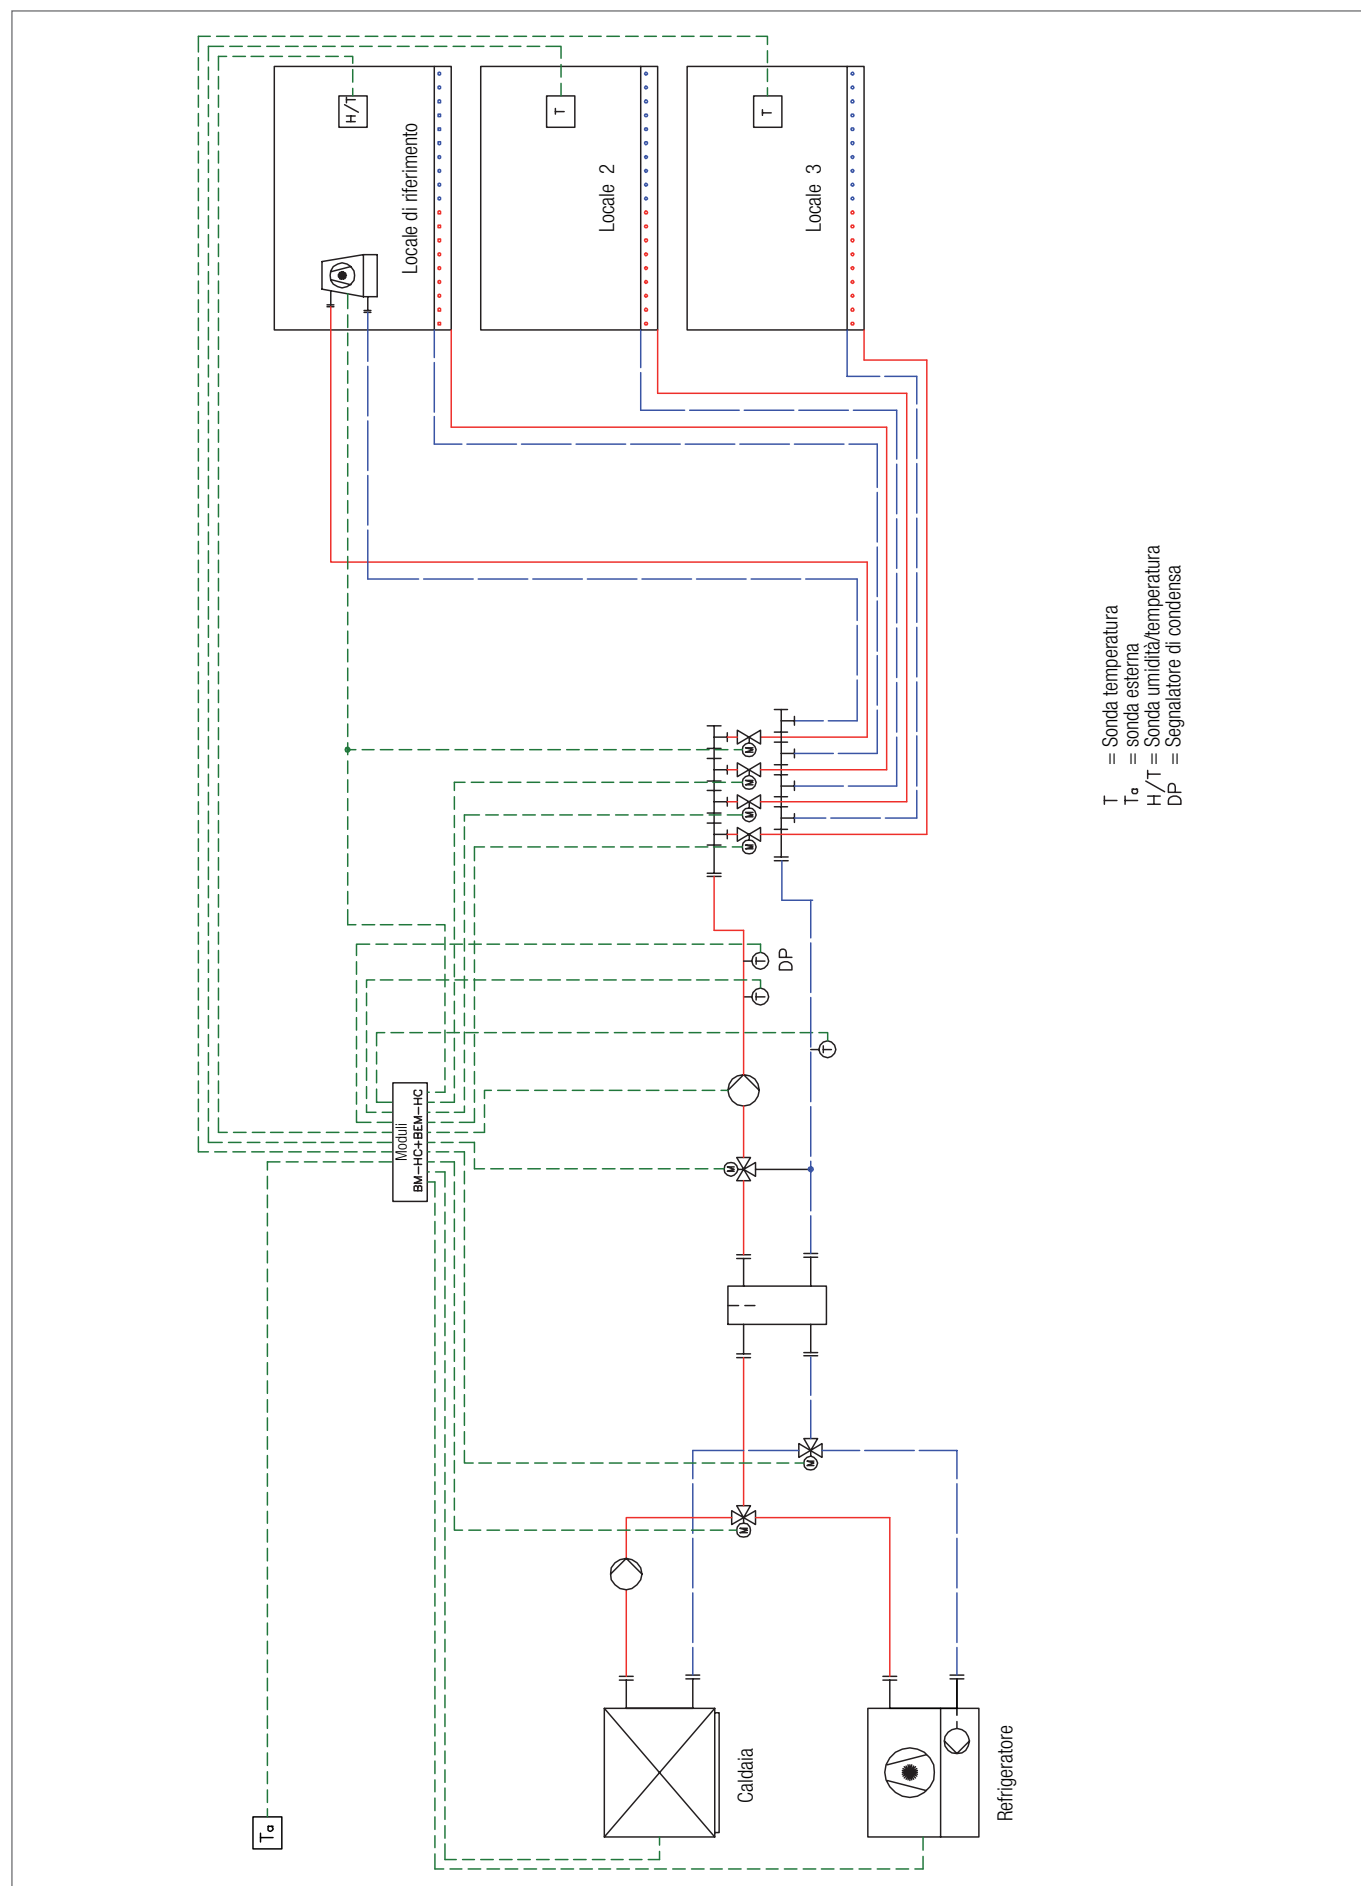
Sistema di riscaldamento/raffrescamento a pavimento, 1 zona
